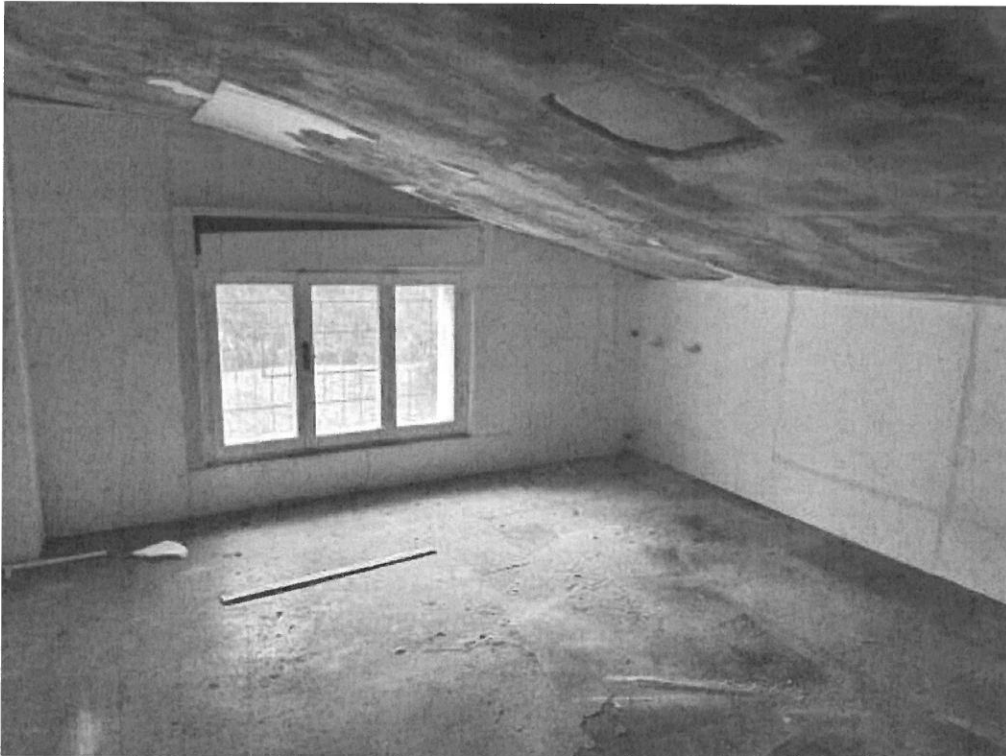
P1 (sub. 3) soffitta angolo Ovest
